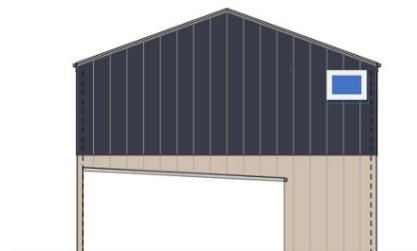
Emplacement du nichoir double sur le pavillon 13 face Nord (coté jardin).
